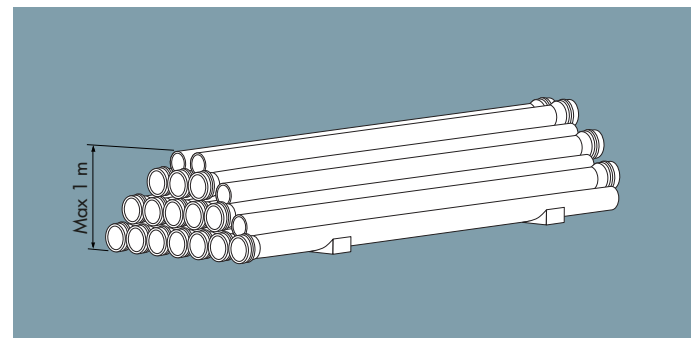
Stoccaggio di tubi in cantiere - Storage of pipes in the building yard
